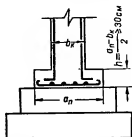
138. Опираание железобетонных колонн на бетонные, бутовые или бутобетонные фундаменты.
